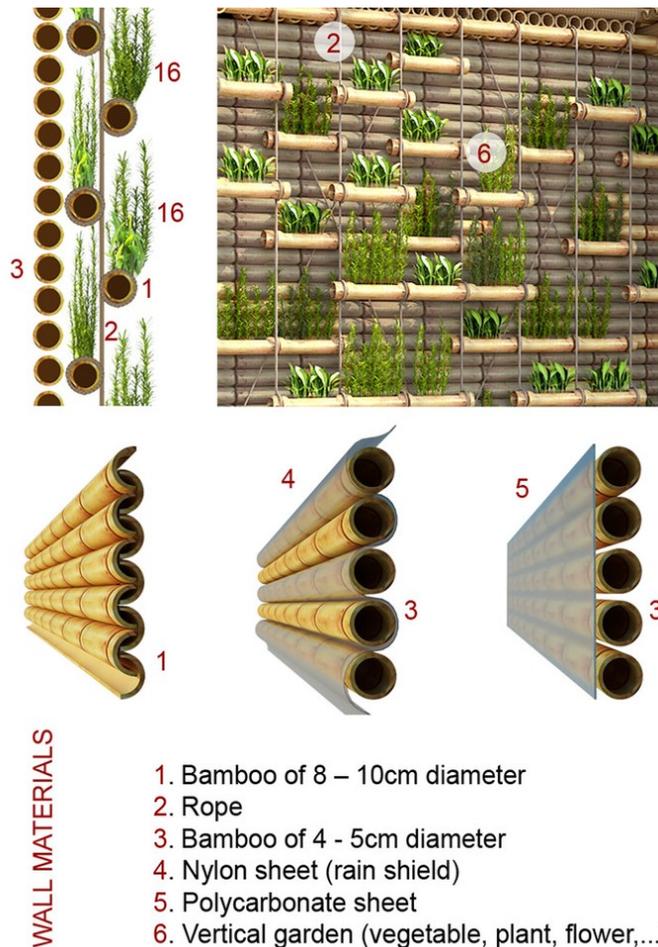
Detalles de impermeabilización. Fuente:(H&P Architects, 2013)
